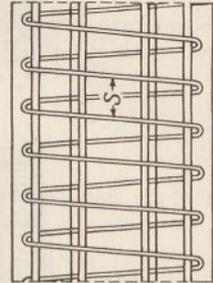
Eisenbetonsäule mit einfacher Bügelbewehrung.
